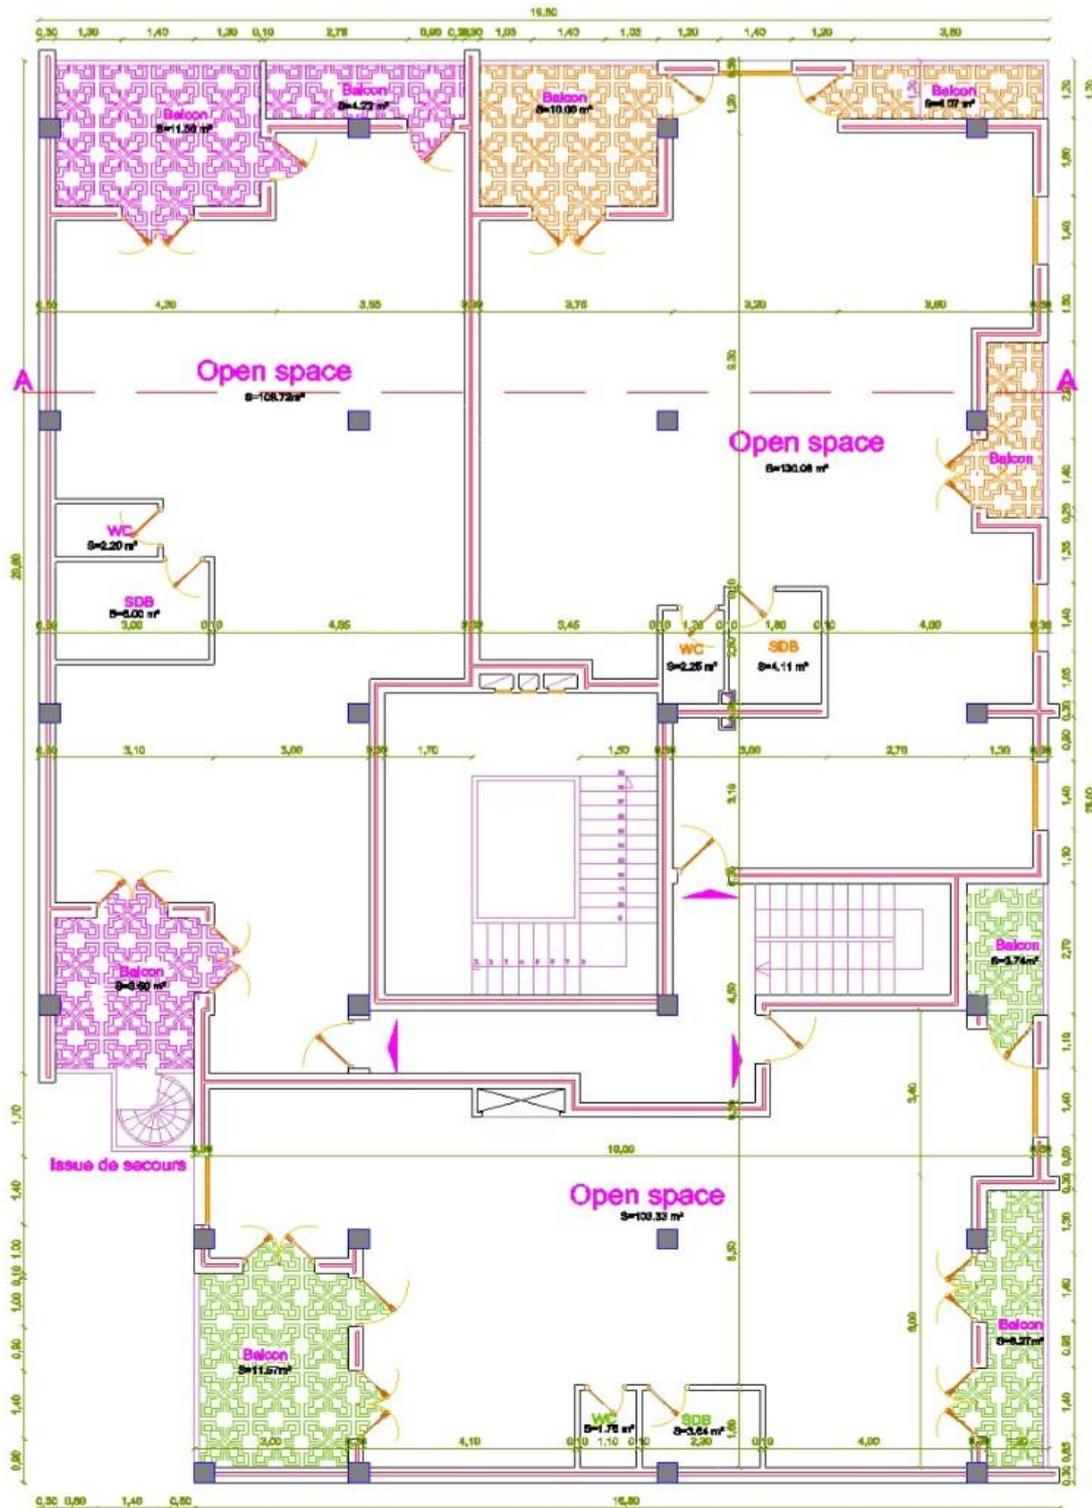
Plan de sol 1^{er} étage bloc A
